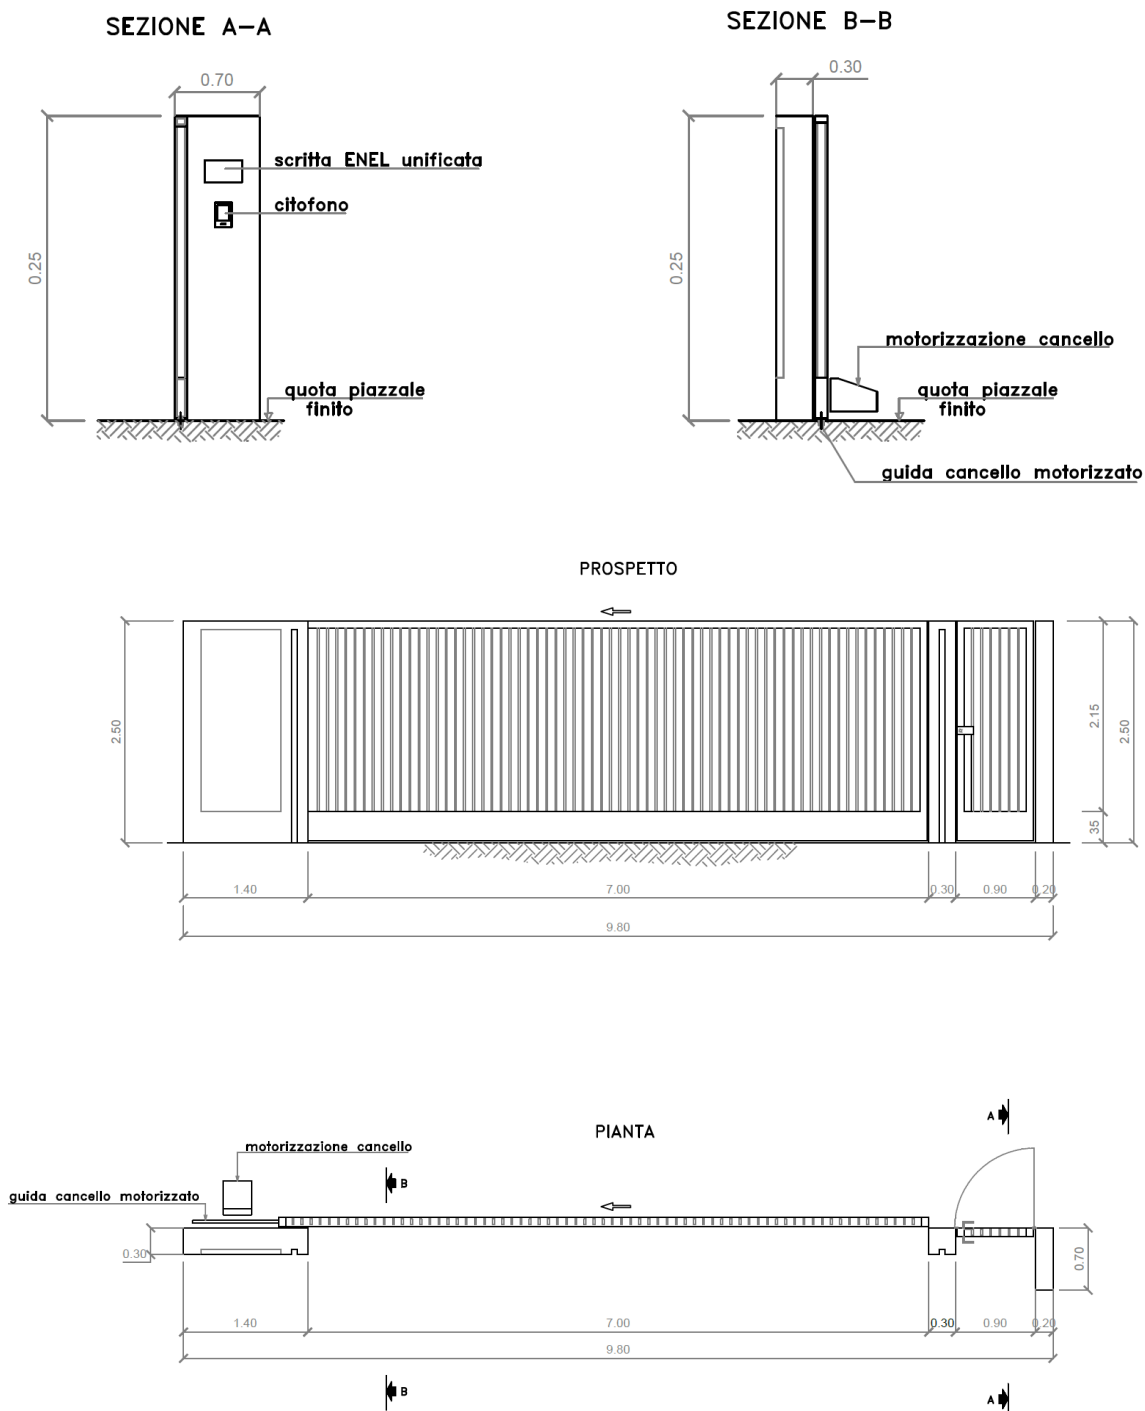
Piante, prospetti e sezioni del cancello di ingresso alla nuova stazione RTN.
